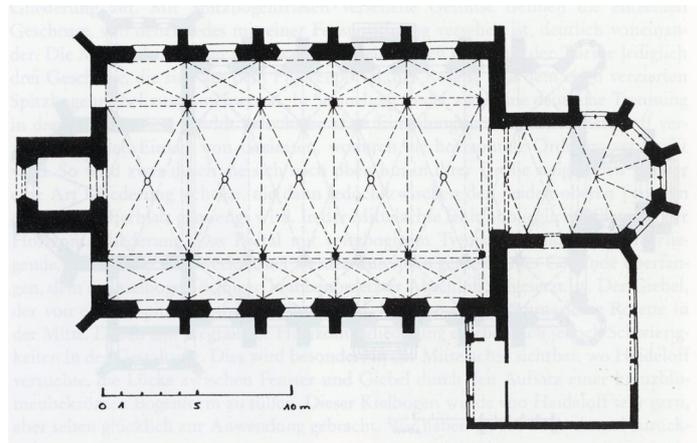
Mergelstetten, ev. Kirche, Grundriß
